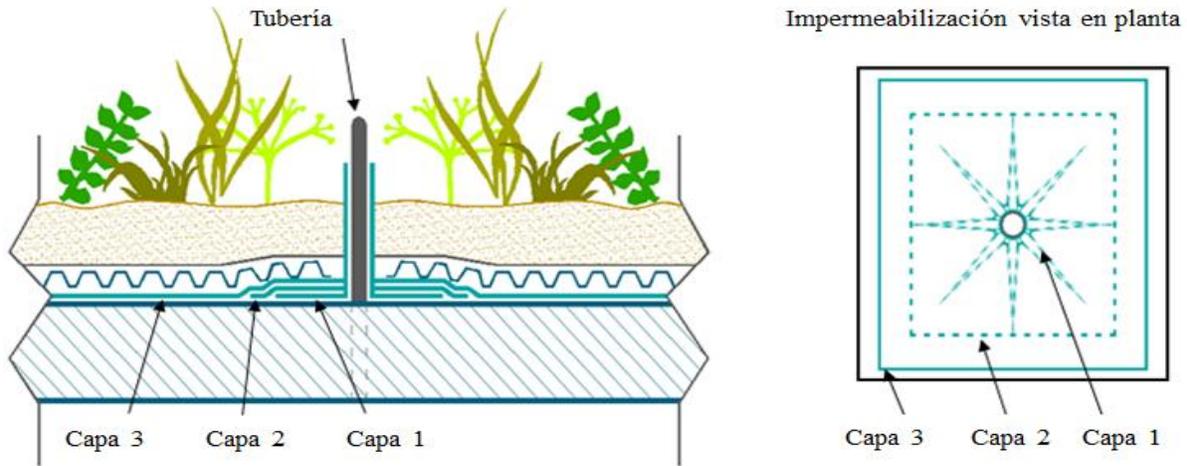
Impermeabilización y refuerzos en puntos de encuentro con tubos y conductos que penetren desde la cubierta hacia el interior de la edificación.
